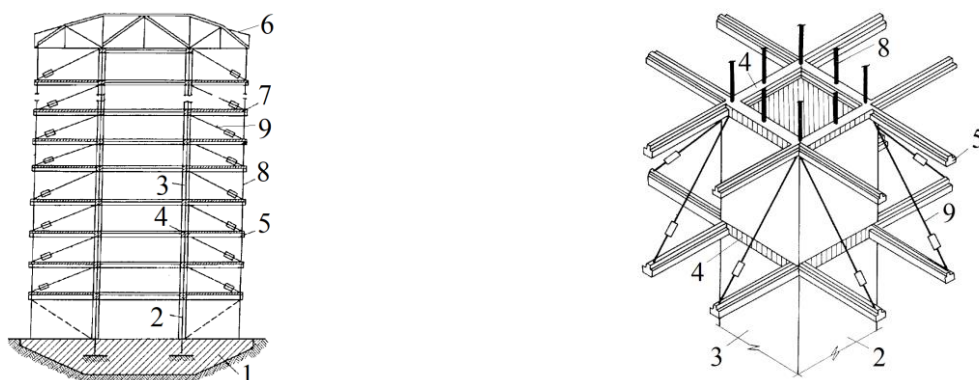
Подвесное сейсмостойкое здание: 1 – фундамент; 2 – центральное ядро; 3 – сборные объёмные блоки; 4 – рёбра жёсткости; 5 – консольные ригели; 6 – консольная ферма; 7 – плиты перекрытий; 8, 9 – подвески
